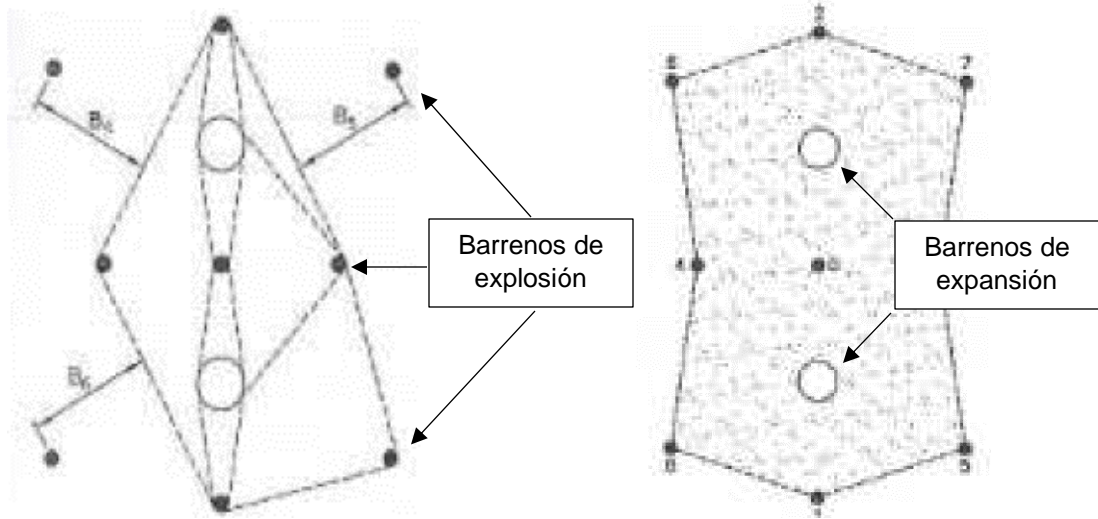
30: Cálculo de geometría. (Carlos López Jimeno et al., 2010)
